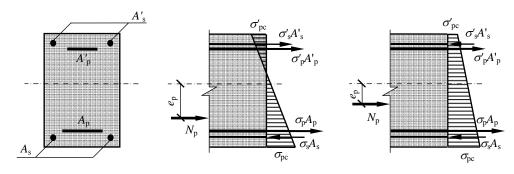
受拉区、受压区均配置预应力钢筋的受弯截面应力
